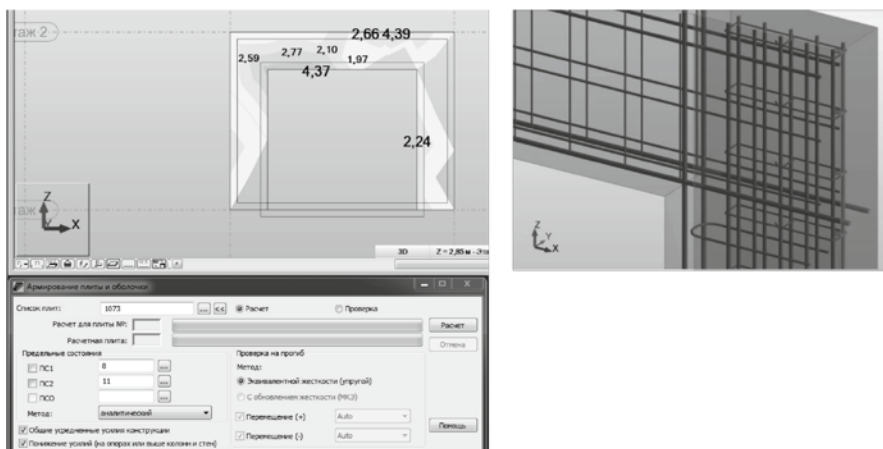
Проектирование железобетонного панельно-рамного элемента
